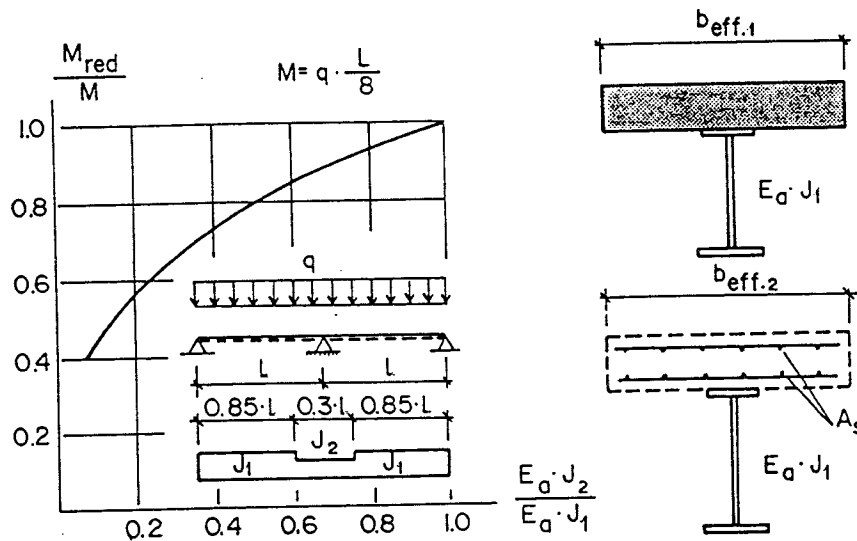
Reducción del momento en el apoyo intermedio, debido a la disminución de la rigidez de la zona fisurada de la viga.
